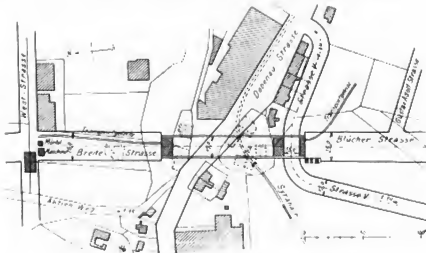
Lageplan der Umgebung der Brücke. — Massstab 1:3000.
